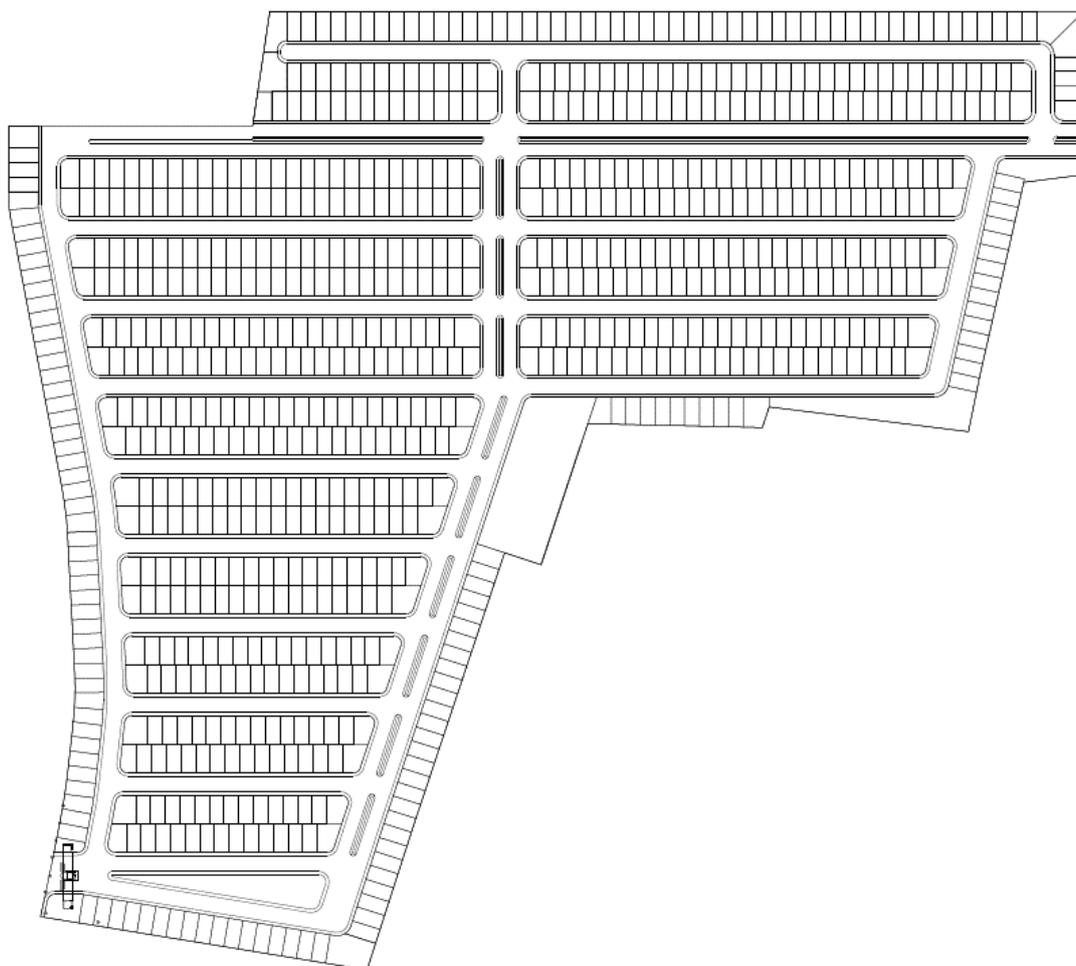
Planta Lotización Cataluña / Elaboración: Igor Muñoz Arquitecto
